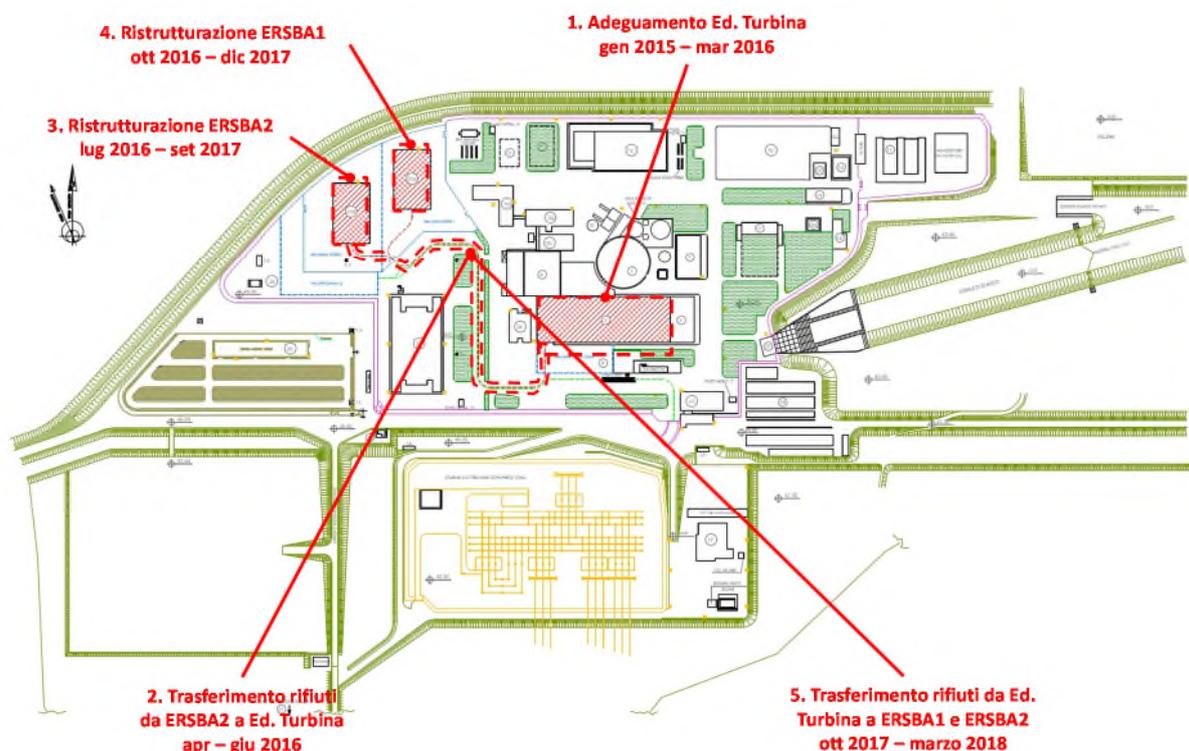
Planimetria dell'area interessata dalle attività con possibile impatto sulla componente atmosfera
